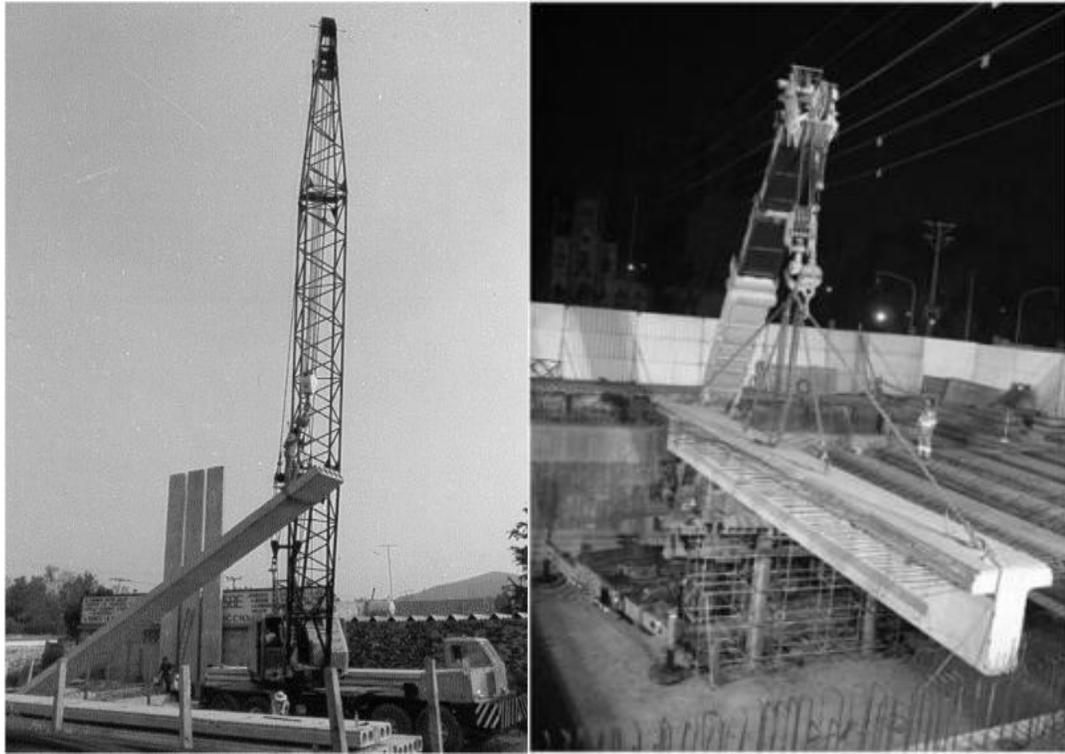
Grúas estructurales para manipulación de elementos presforzados
